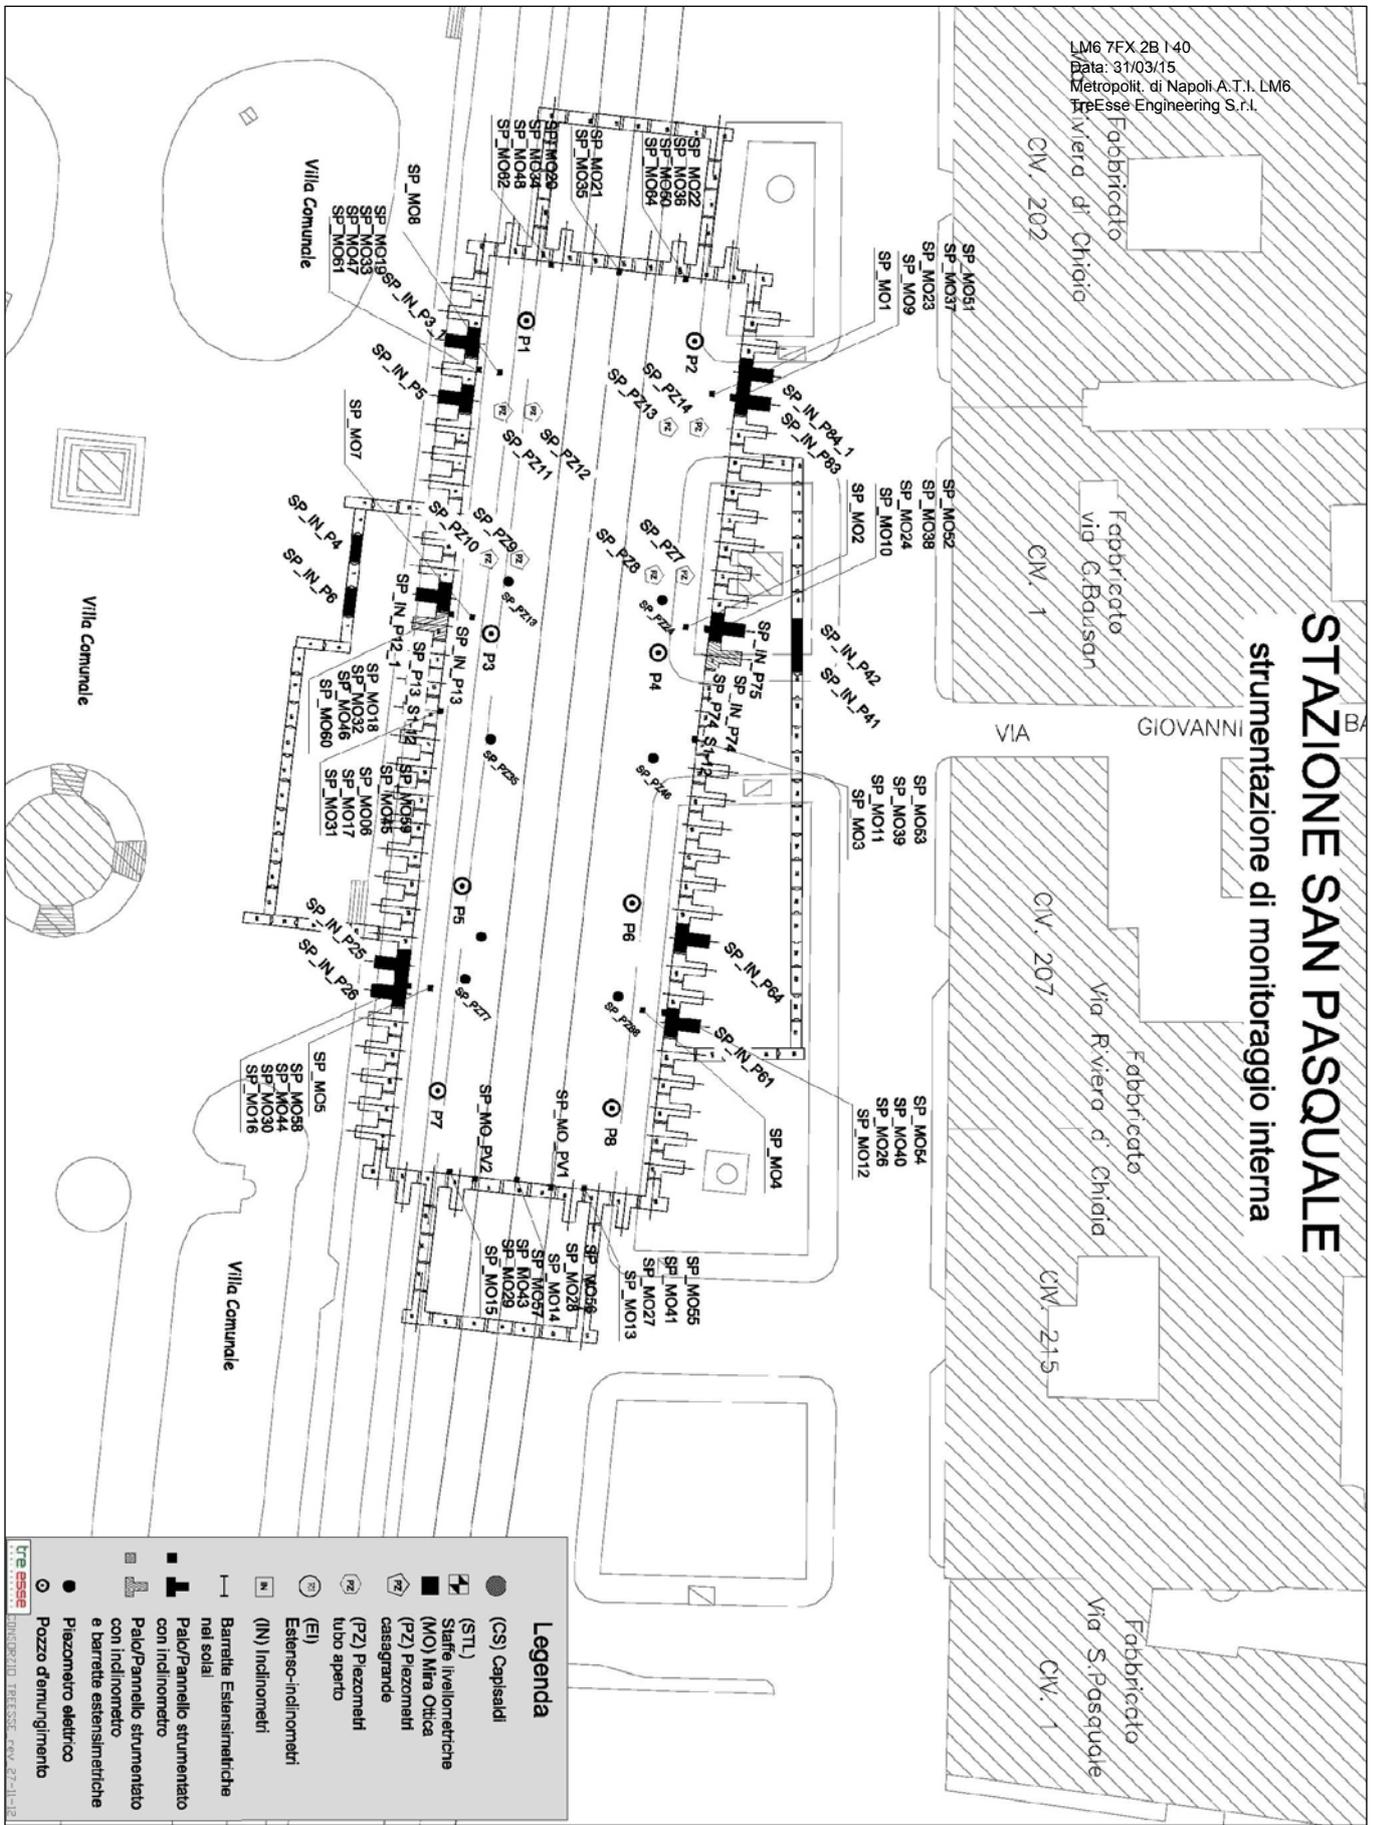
Planimetria pozzo stazione, raffigurante la disposizione della strumentazione di monitoraggio geotecnico interna.
